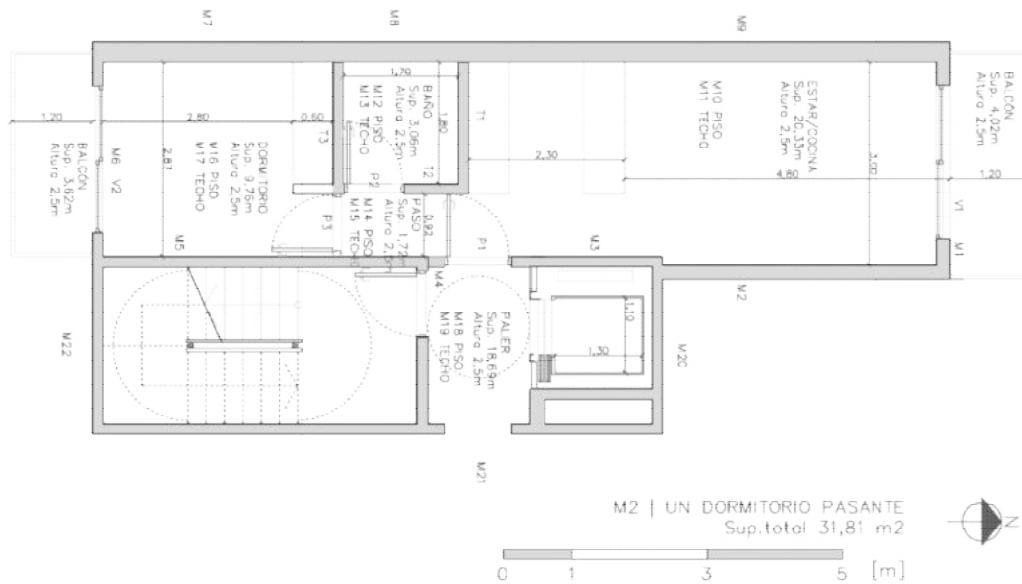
Esquema de planta del módulo M2. Fuente: Elaboración propia del equipo.
